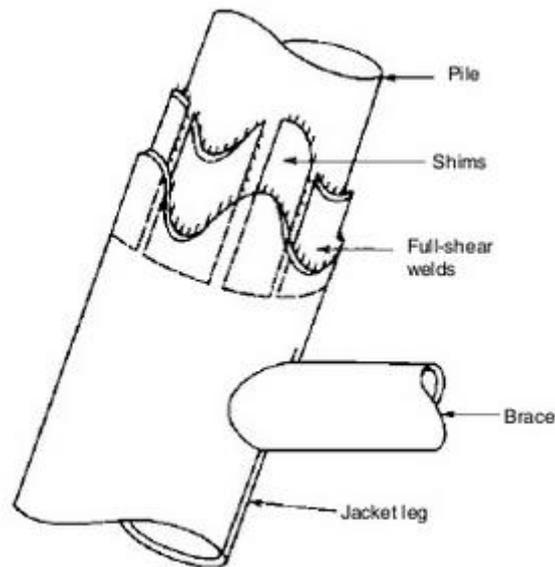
Unión entre el pilote y la pierna del jacket. Fuente: Construction of Marine and Offshore Structures.
